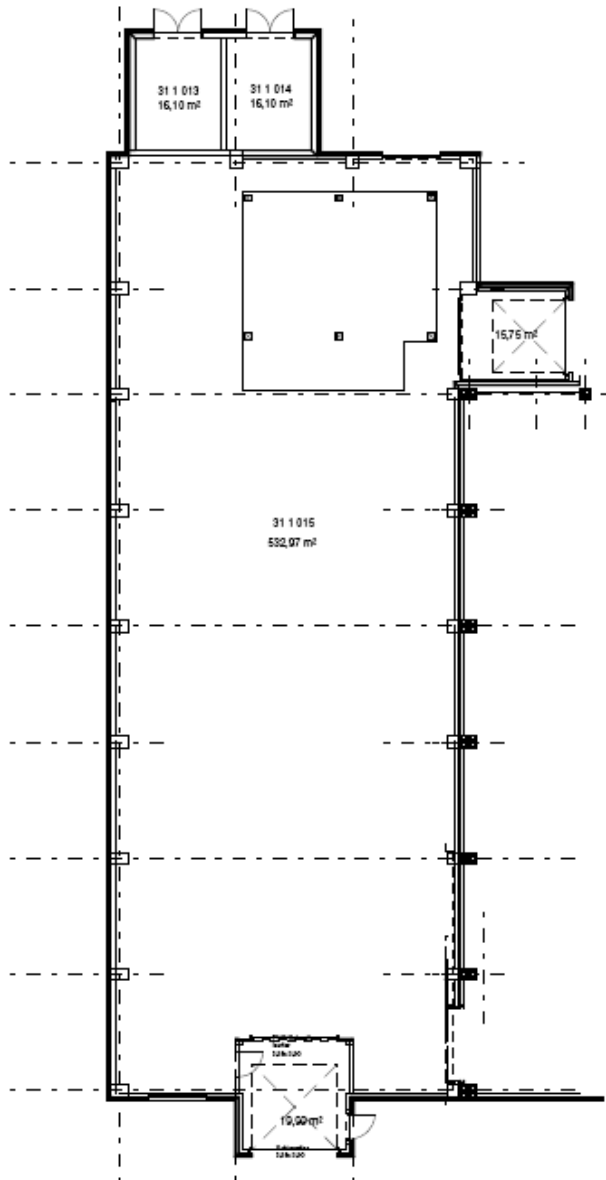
Grundriss B_31, Osthalle, Bauabschnitt 2
